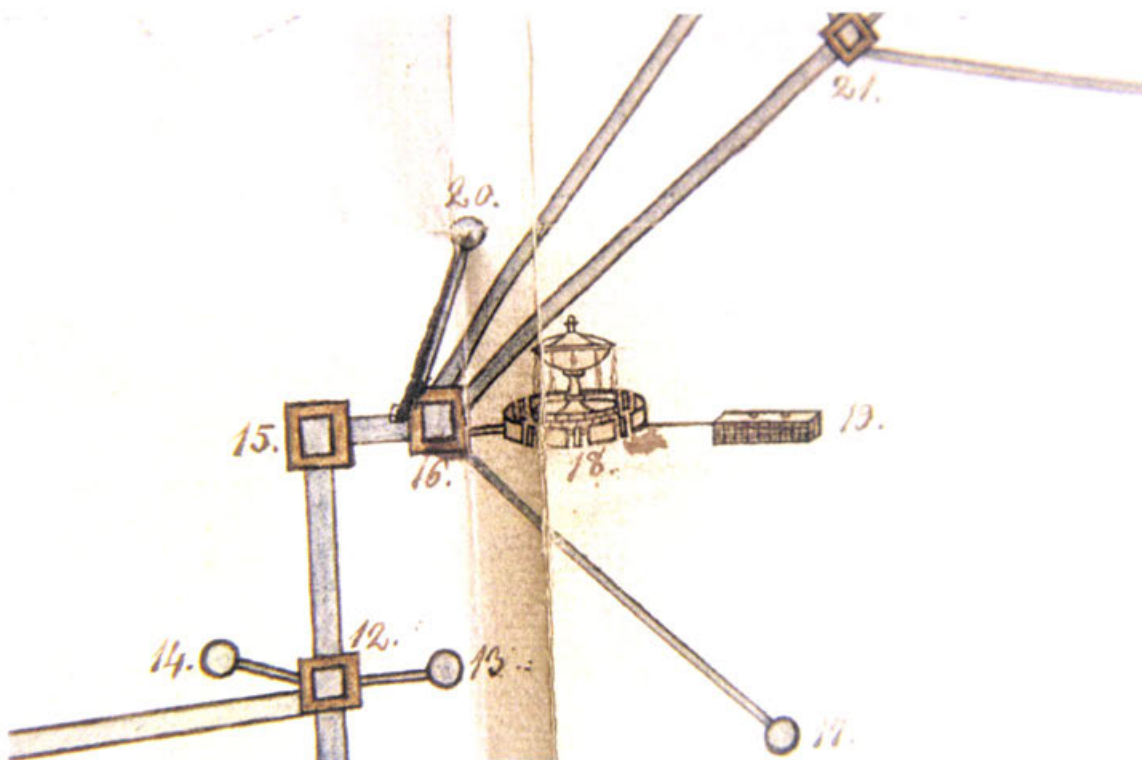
Caixa de registo assinalada na planta com o número 16.
